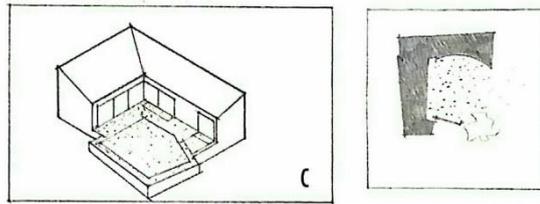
1 Sketsa dan Layout Ruang A
